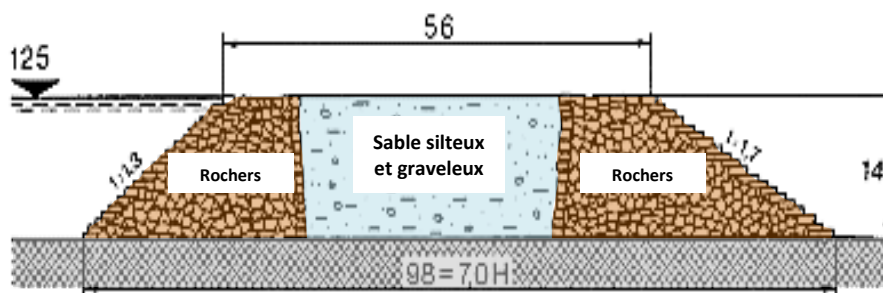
Coupe transversale du barrage de Sadd el Kafara
